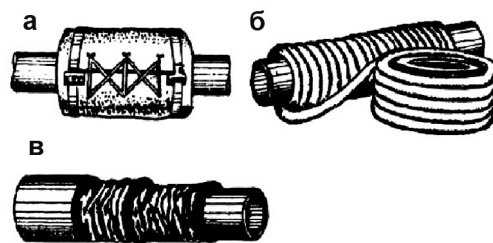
Изоляция трубопровода оберточными конструкциями
